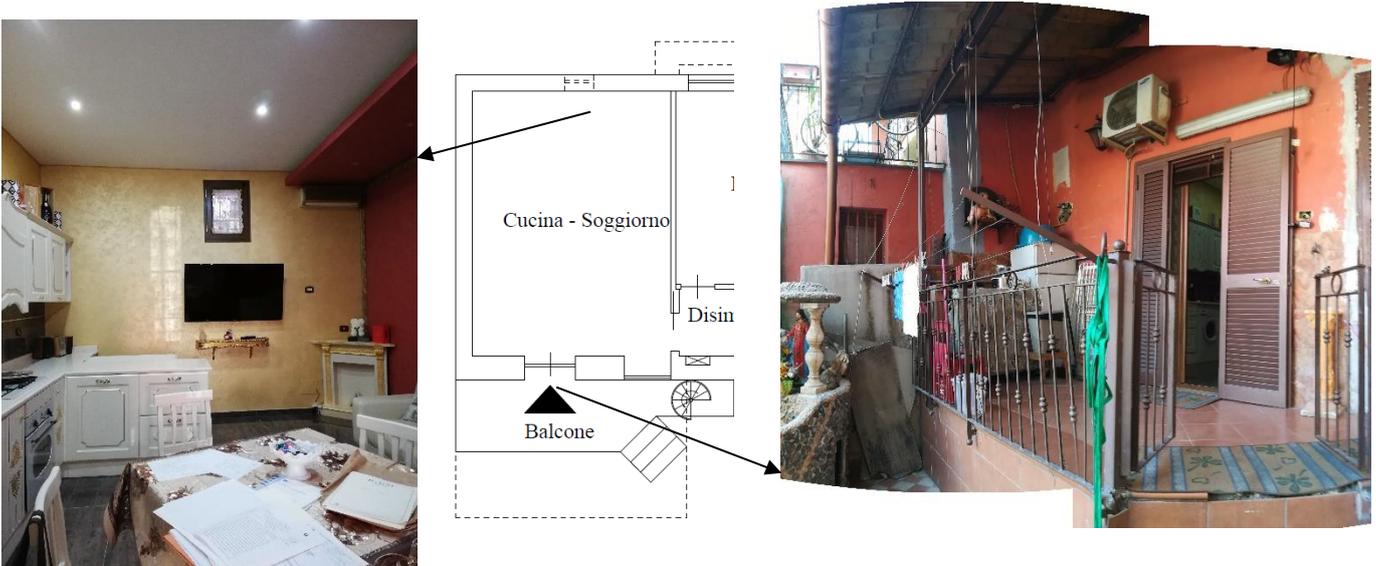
Individuazione fotografica degli interni del bene oggetto di pignoramento.
